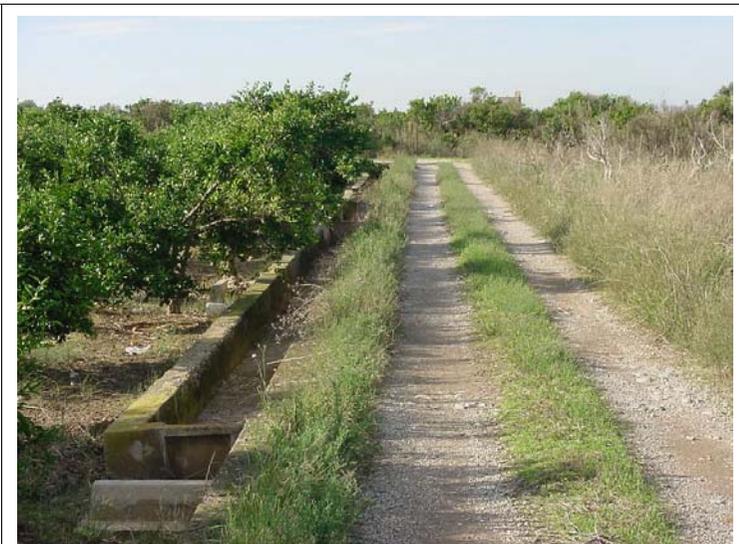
Acequia de 70x30 cm, camino en tierra y murete de 20x20.
